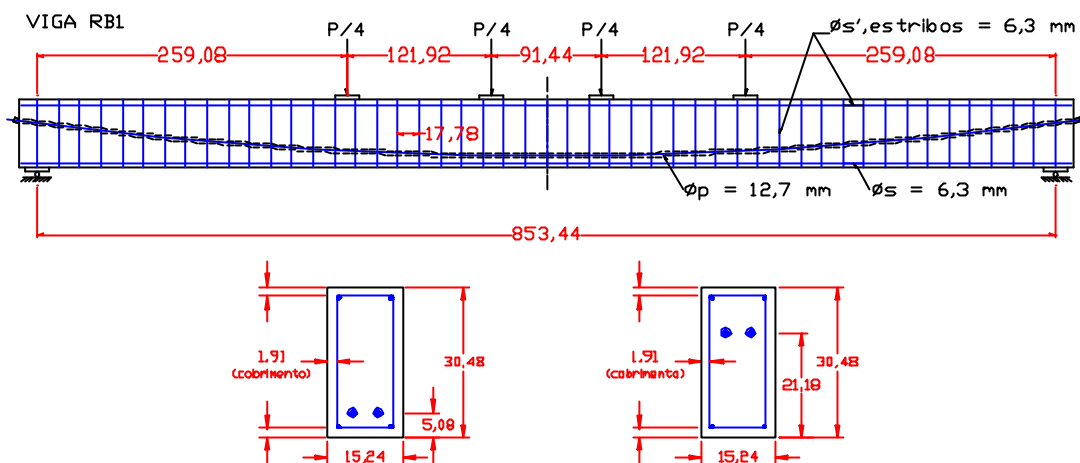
Detalhamento da viga RB1 (cotas em cm)
